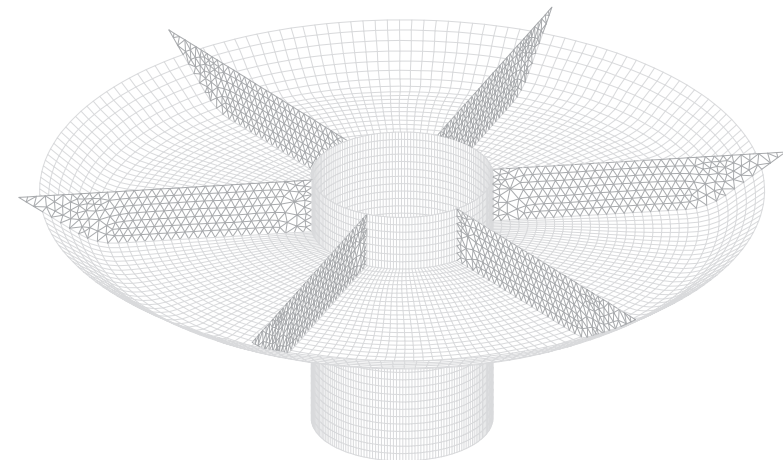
Modelización de las vigas inferiores en elementos finitos
